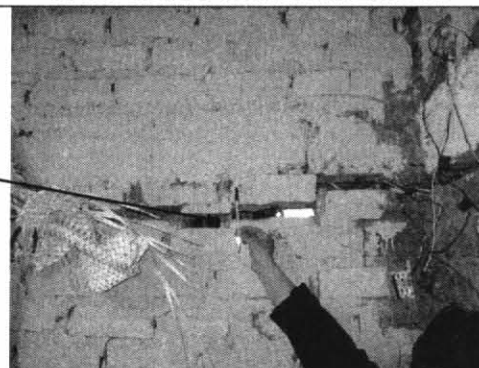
Predio de la señora Carme Elisa Castro y zona donde se desarrollan las obras del proyecto Cantarrana.
